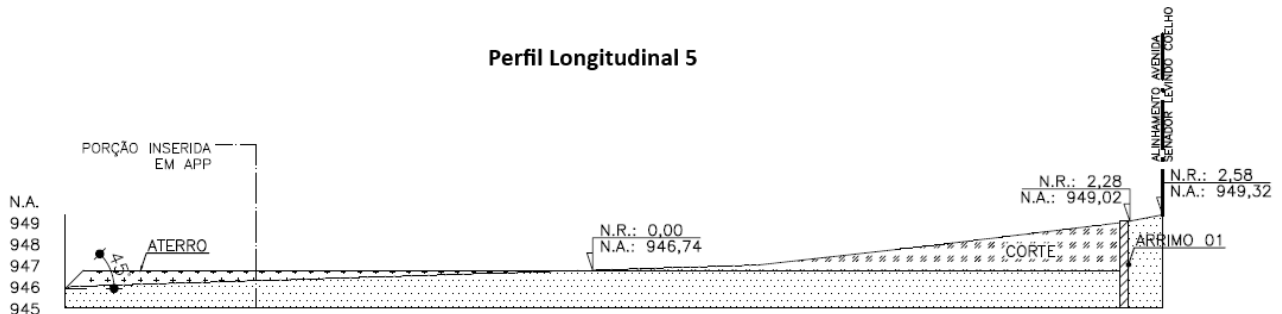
Perfis Longitudinais. Disponível no ticket 31.00732592/2025-08.
